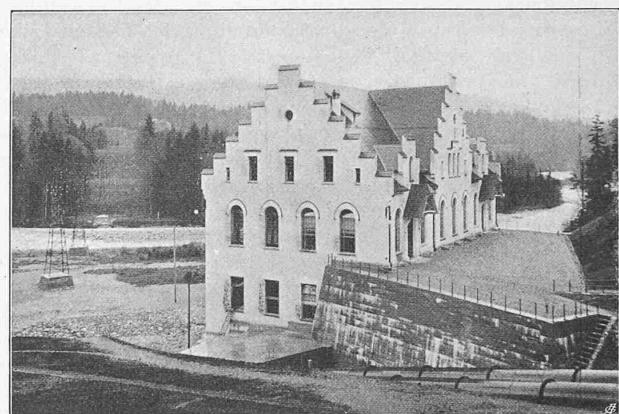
Seiten- und Rückansicht des Maschinenhauses.
